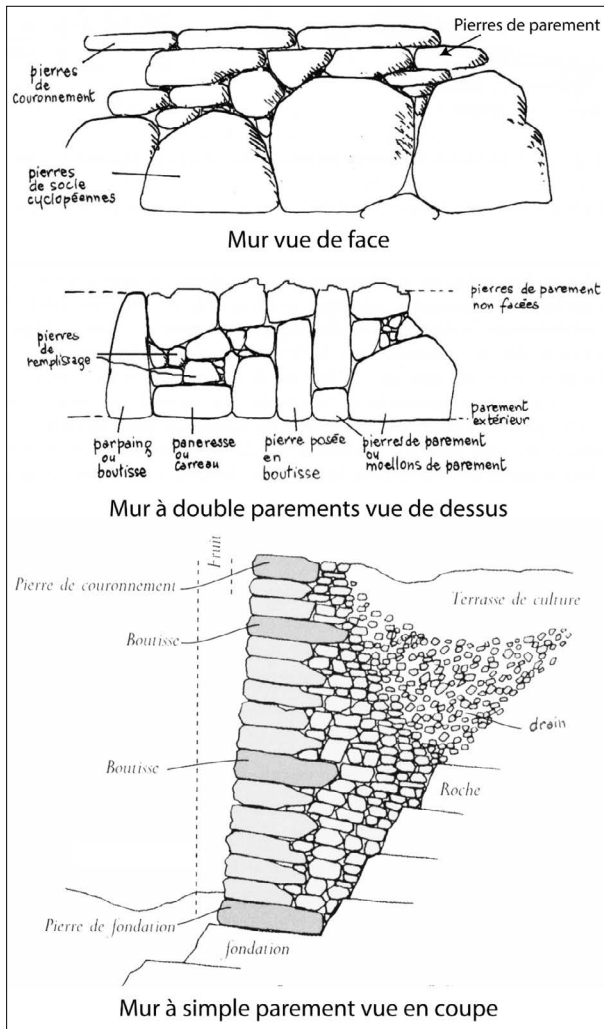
Terminologie des pierres dans la construction en pierre sèche (vue de face et de dessus: d'après CAPEB 2008, vue en coupe: d'après Lassure 2008).
